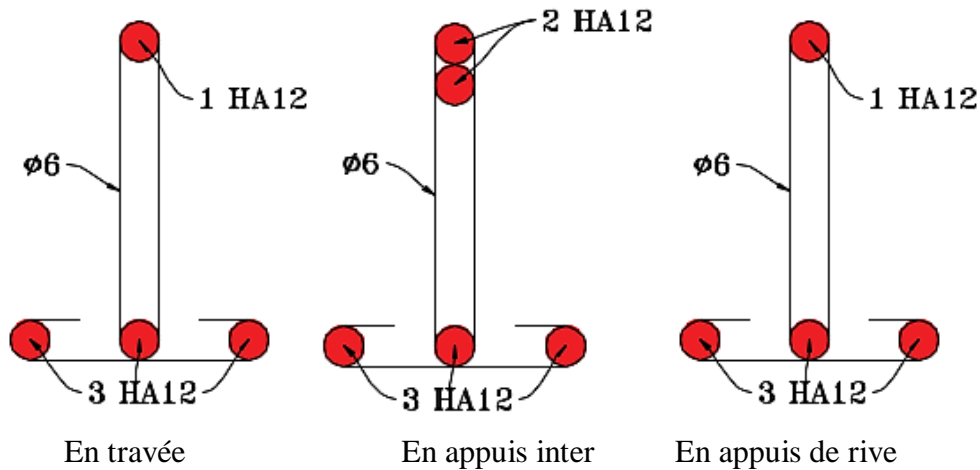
Schémas de ferrailage des poutrelles de la terrasse accessible.
